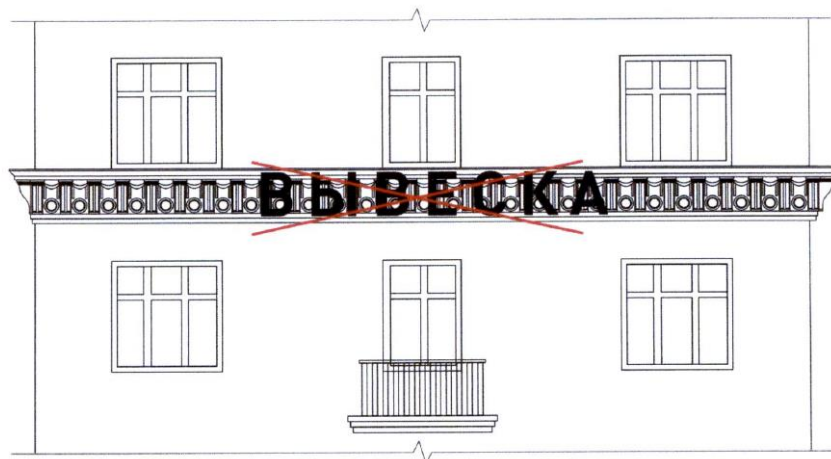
Неправильное размещение вывески, закрывающей декоративные элементы фасада.
